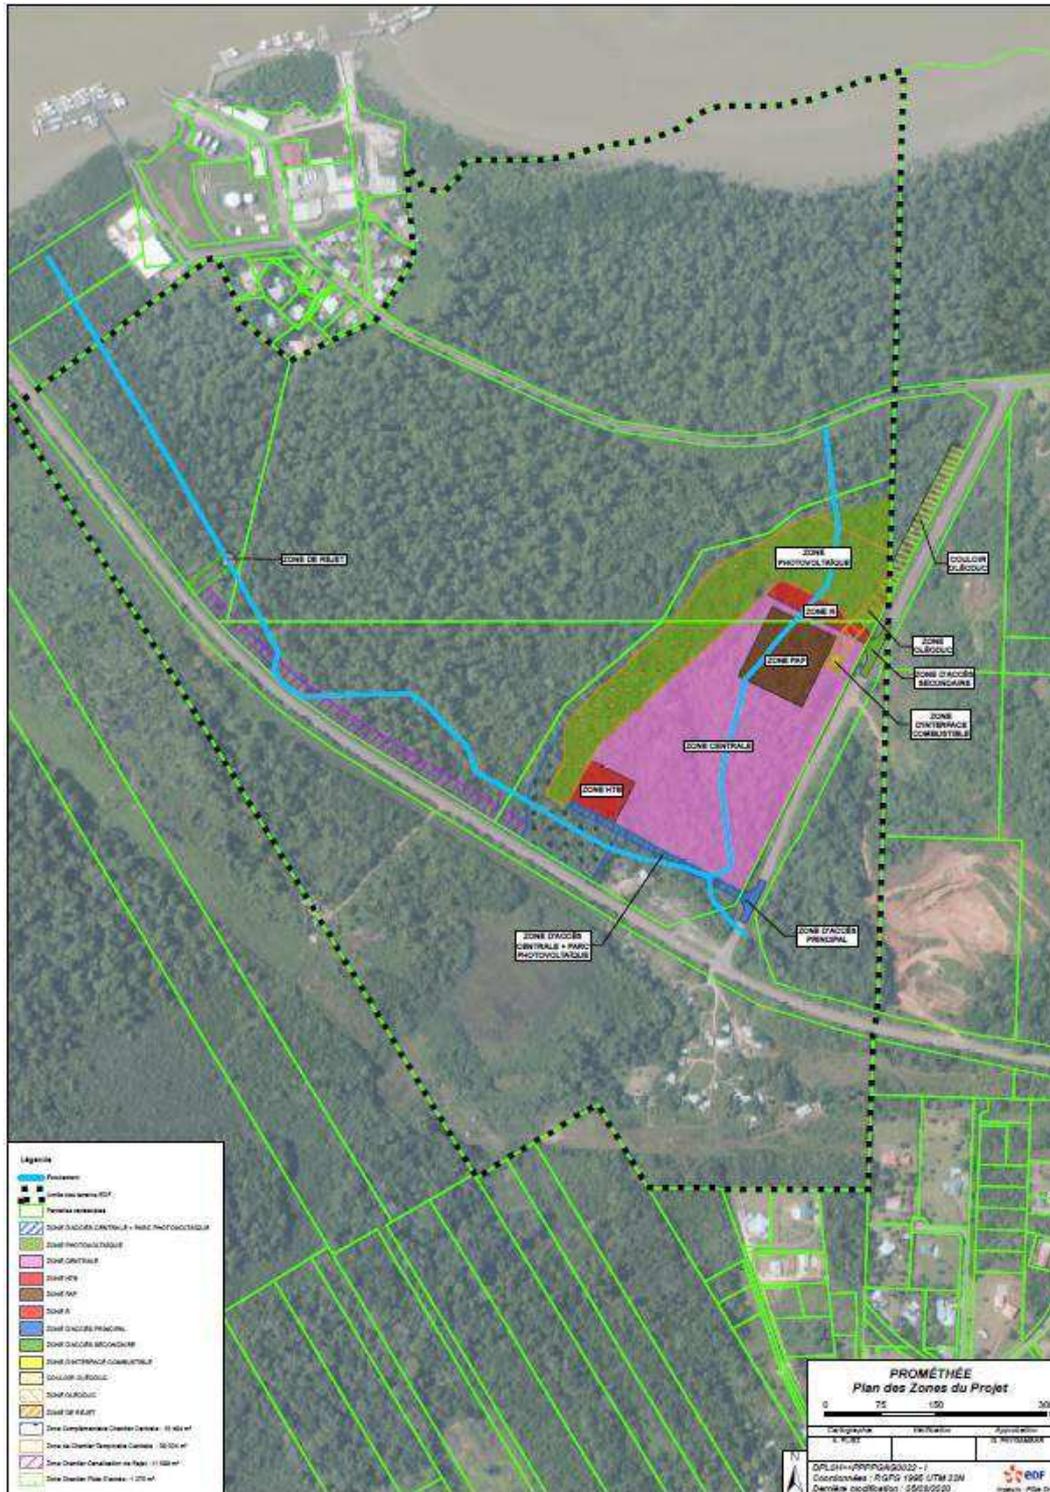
Plan des zones de chantier (Source : EDF PEI)
